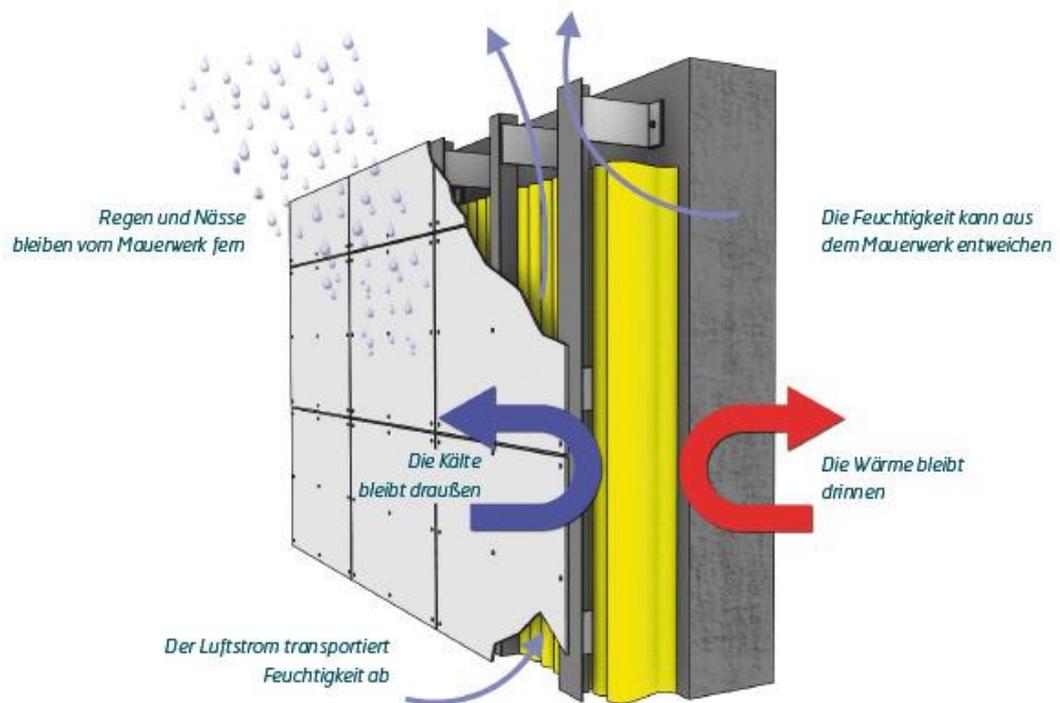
Exemplo de funcionamento de revestimento metálico em fachada ventilada
